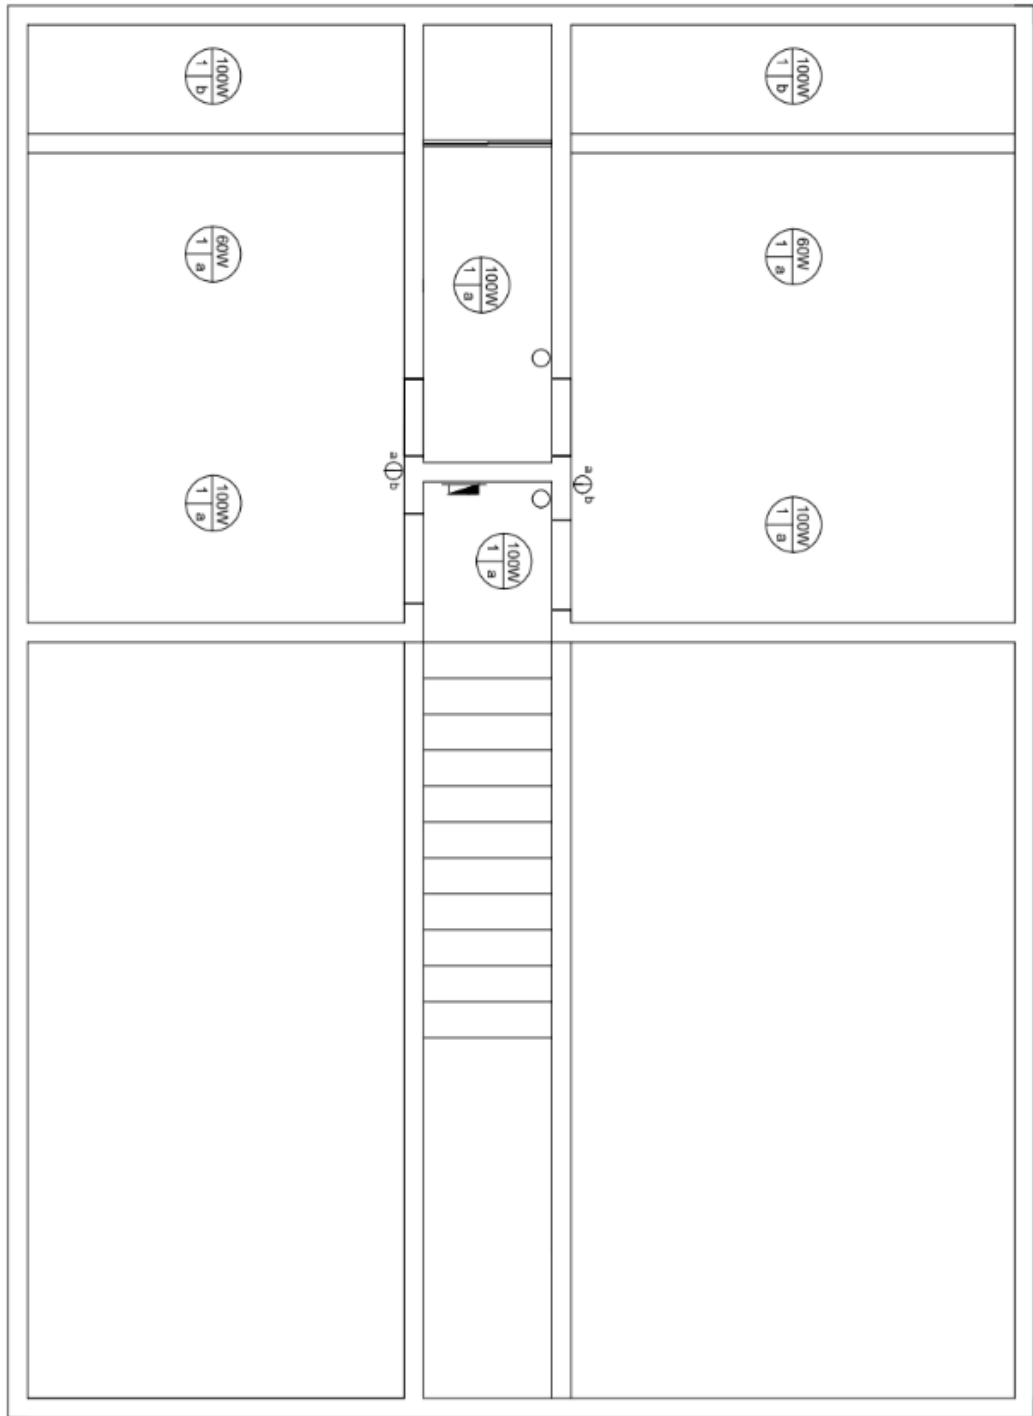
Planta Baixa de Iluminação Pavimento Superior
